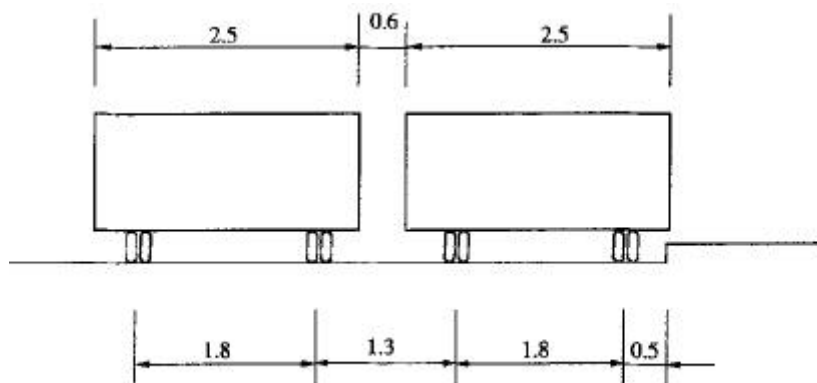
车辆荷载横向布置(图中尺寸单位为 m)
